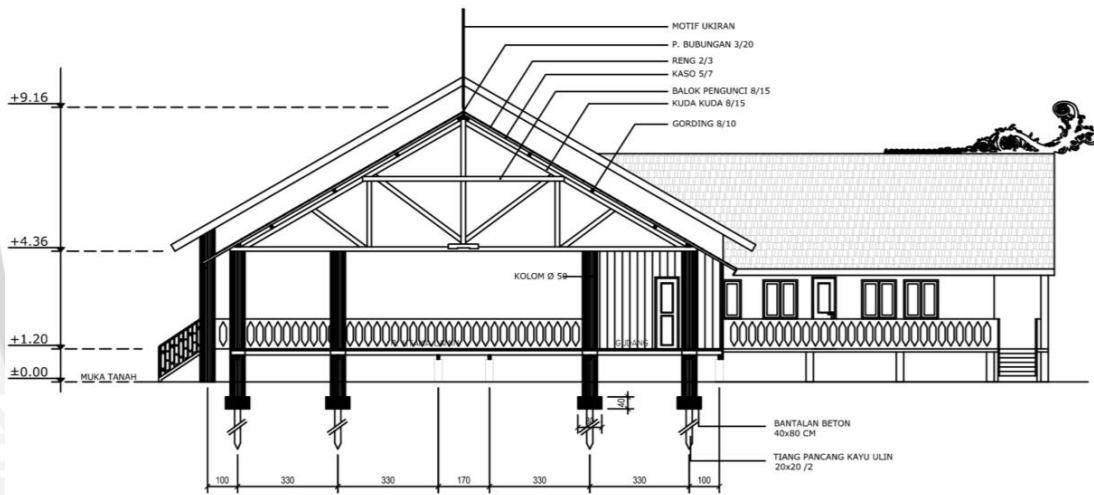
Tampak Lamin Adat Desa Pampang
